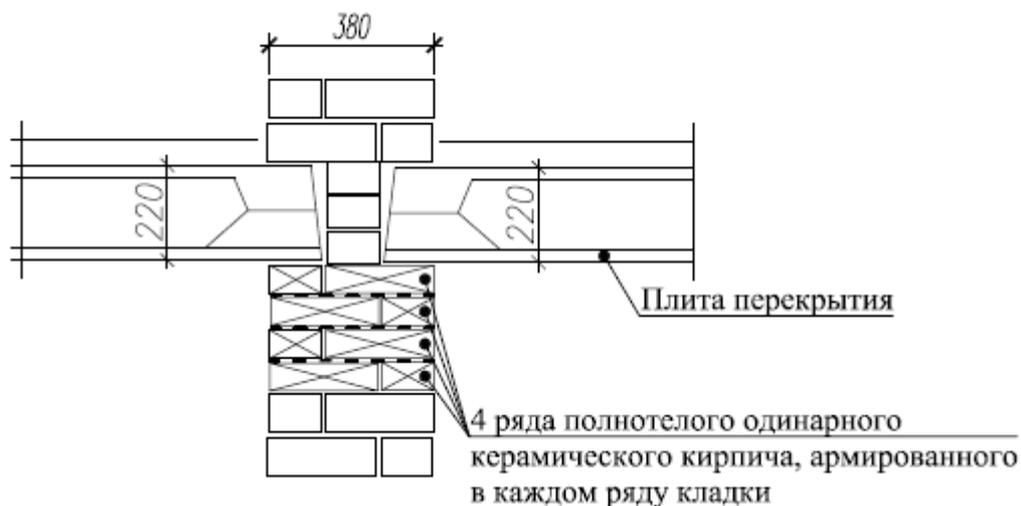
Схема армирования кладки при опирании плит перекрытия
